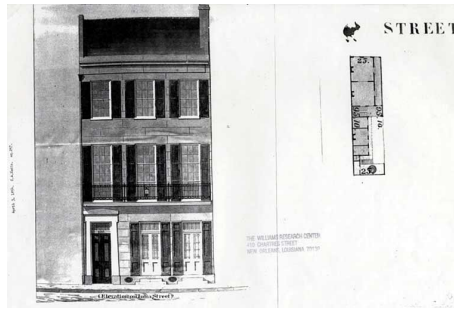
Plan d'un immeuble de style anglais construit sur Julia Street en 1854, dans le quartier anglo-américain (archives Williams Research Center, New Orleans)
